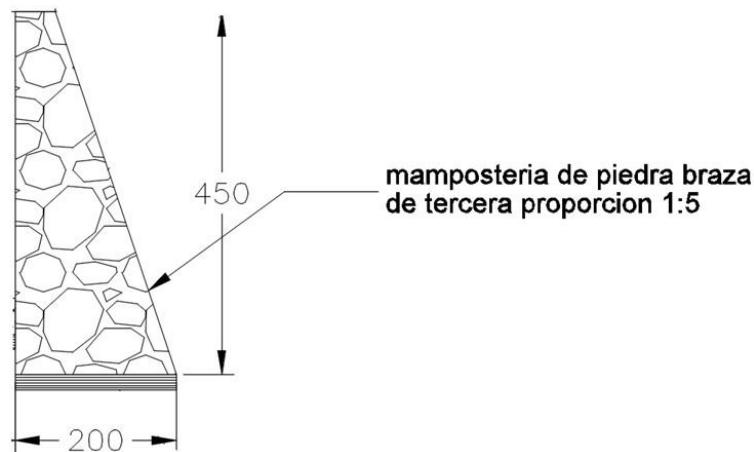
Corte esquemático de la mampostería a emplearse.
